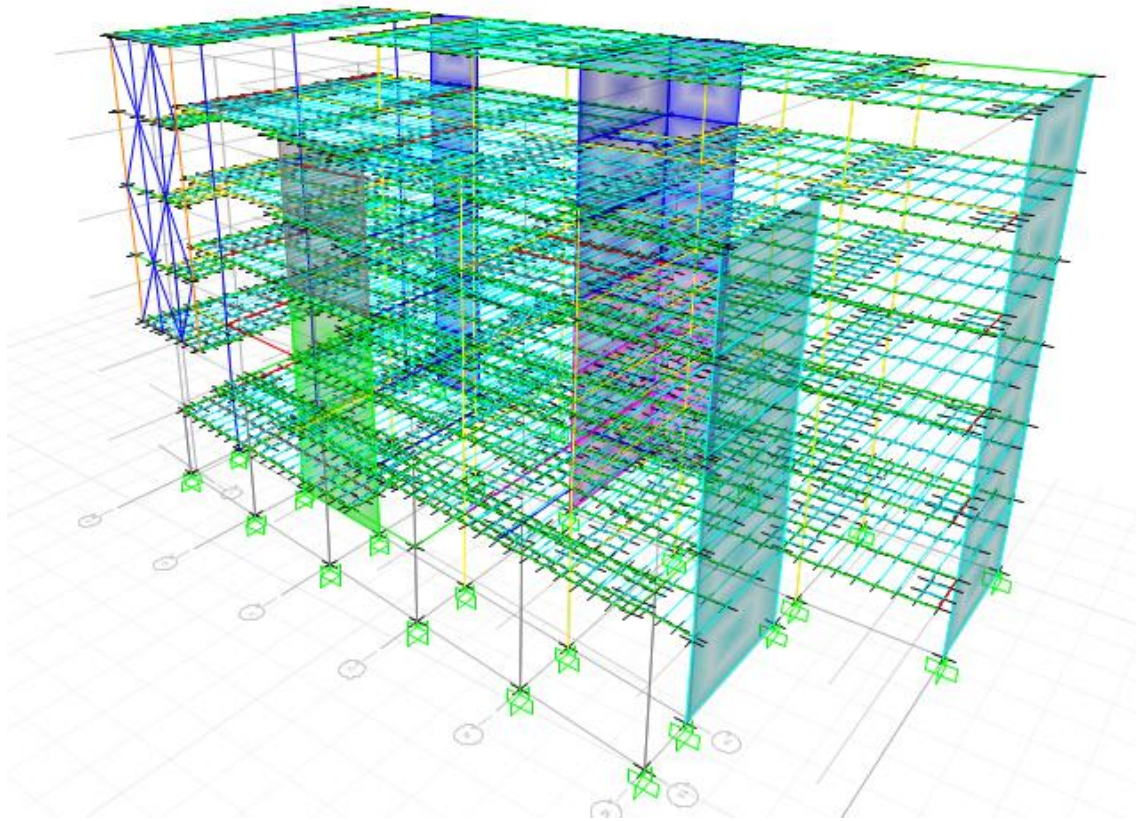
Modelo Estructural de la Segunda Edificación, FUENTE: ETABS
